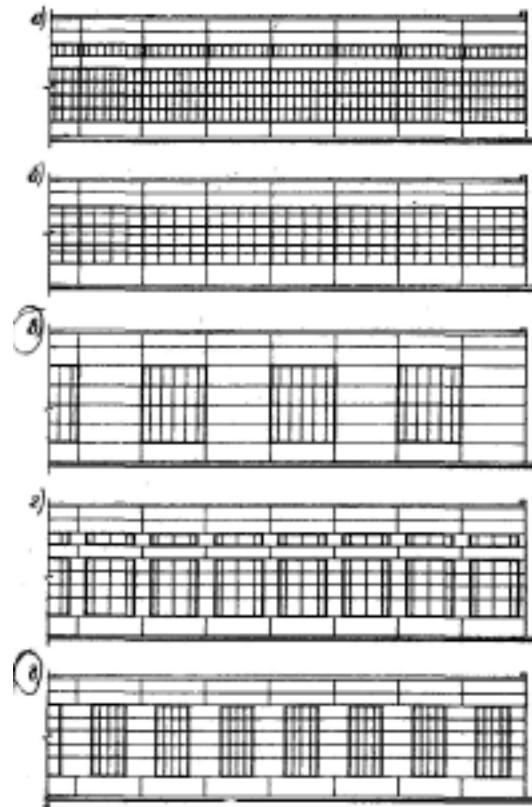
Варианты разрезки стен одноэтажных зданий:
